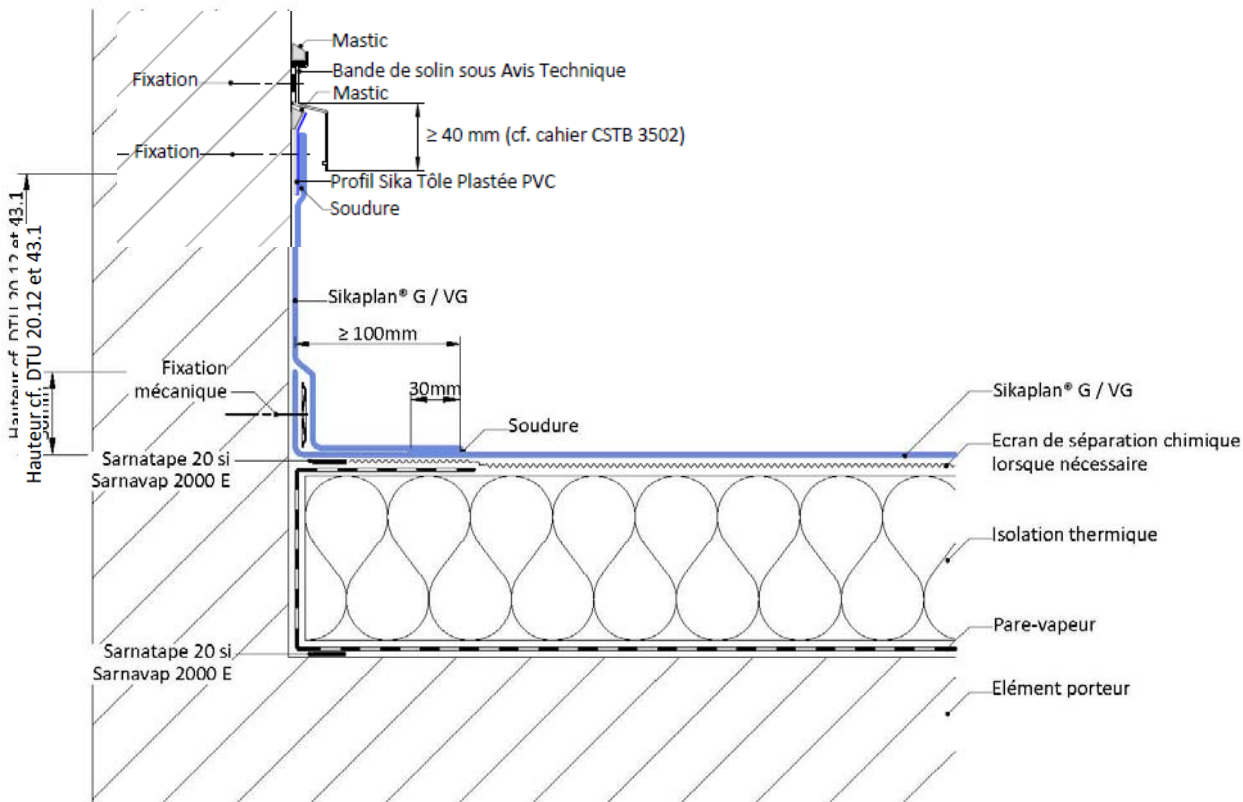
Relevé d'étanchéité sous bande de solin – Variante avec profil Sika Tôle plastée PVC - Travaux neufs sur maçonnerie
